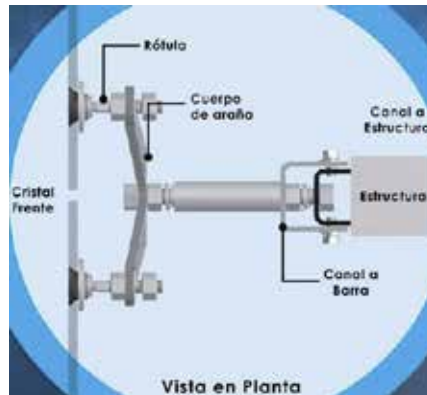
Estructura tipo araña. Fuente: <http://www.kinetic.com.mx> (2016)
